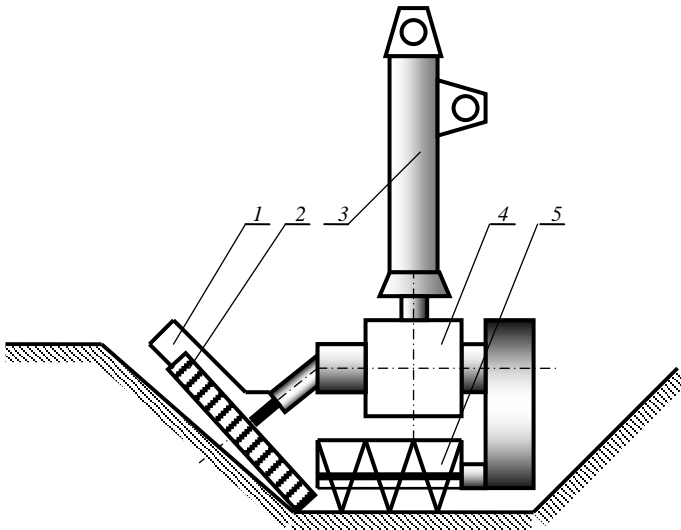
Схема комбинированного шнекофрезерного рабочего органа с цилиндрическим шнеком: 1 – кожух; 2 – дисковая фреза; 3 – рукоять; 4 – редуктор гидропривода; 5 – цилиндрический шнек
